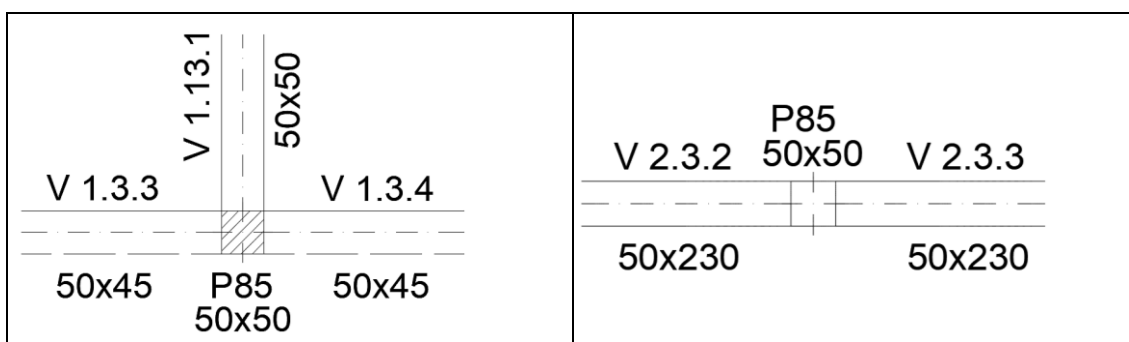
Esquema, em planta, do pilar 85 na laje do piso 1 (esquerda) e na laje da cobertura inferior (direita)
